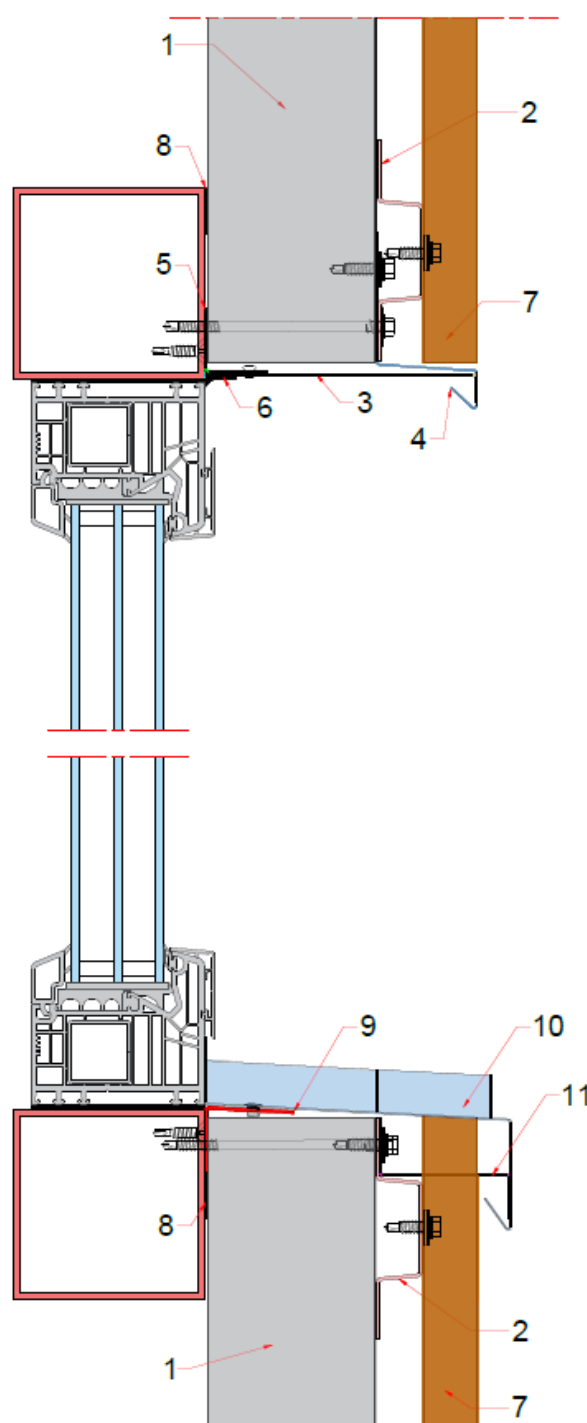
quater : Exemple de baie avec parement extérieur de la typologie 1 sur double réseau avec panneaux sandwich isolants posés horizontalement – Coupe transversale
